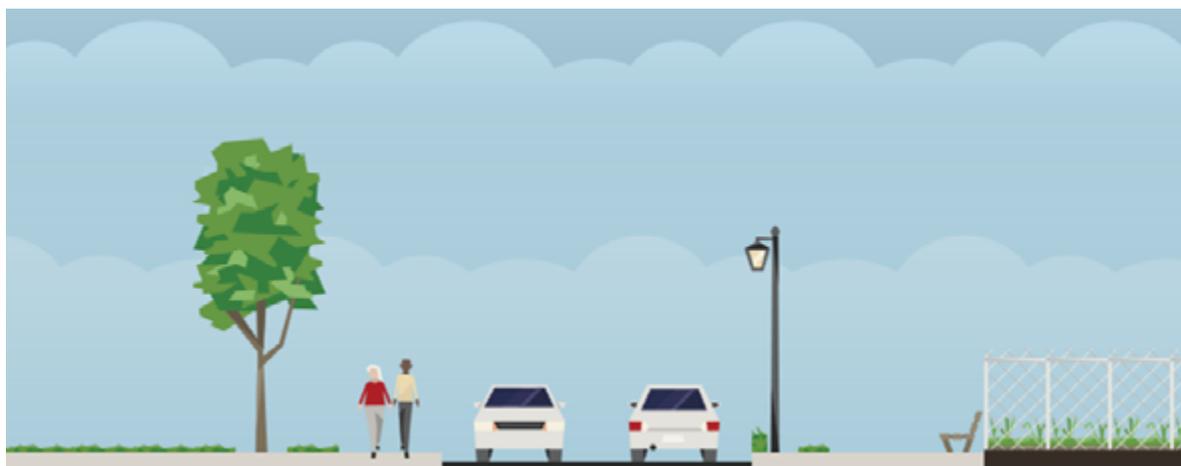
Exemple de profil possible pour la voie d'accès technique (source : 3M)
